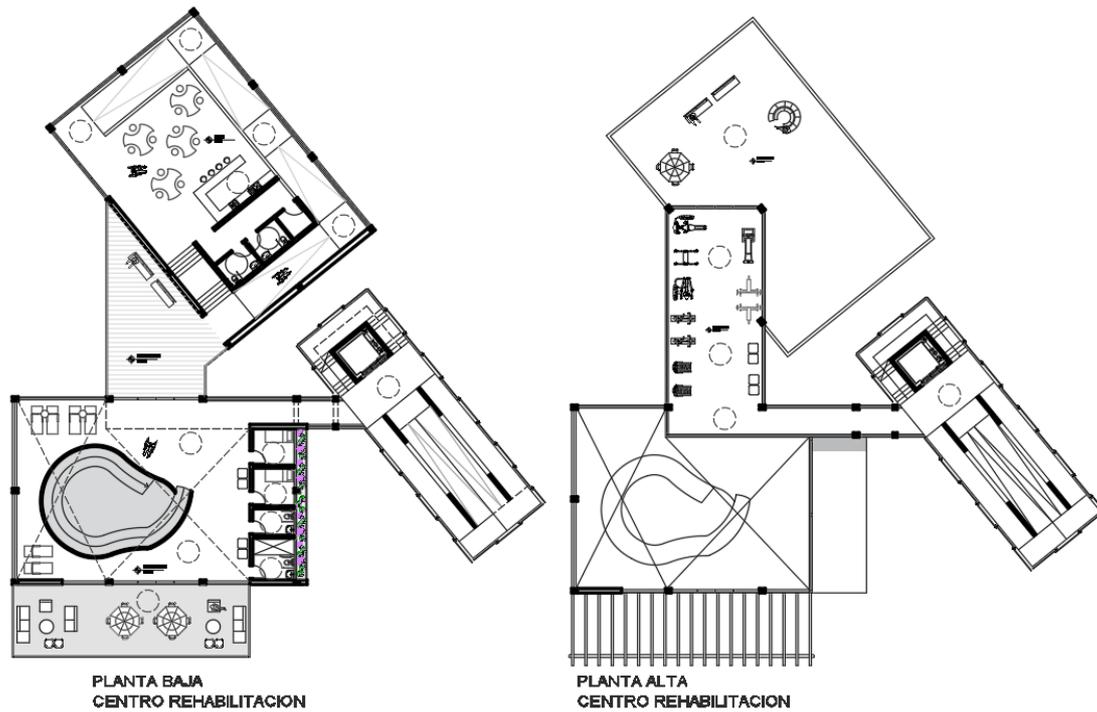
Planta baja y alta del centro de rehabilitación. (Vinuesa, B.)
